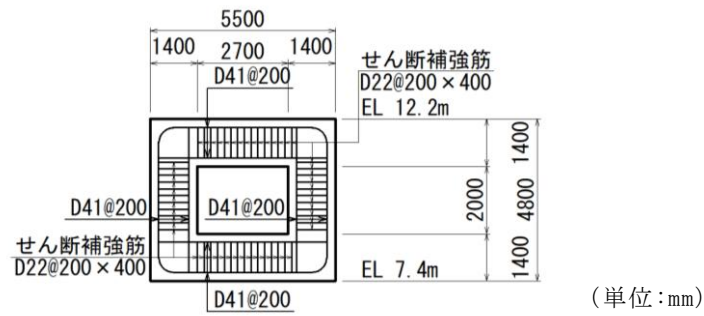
第 1 ベントフィルタ格納槽概略配筋図 (D-D 断面)
